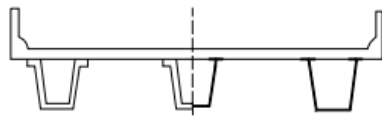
Secciones compuestas por hormigón armado y hormigón armado presforzado en vigas cajón [35]
